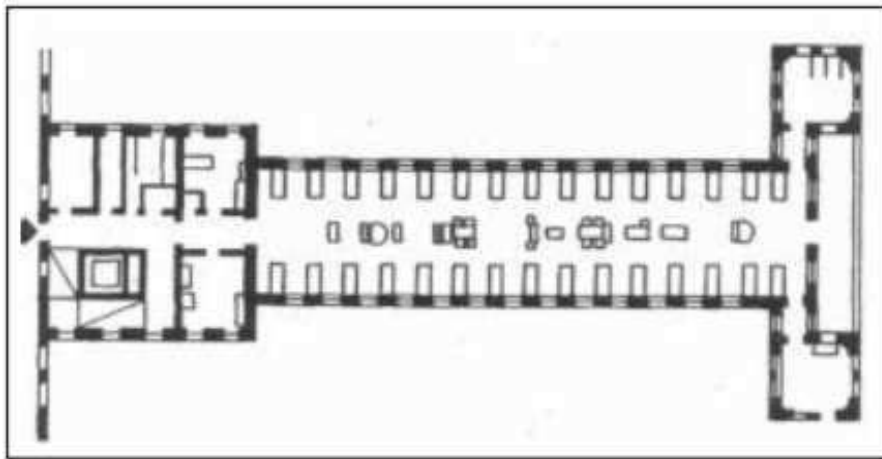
Modelo de planta baixa ideal de Florence Nightingale
